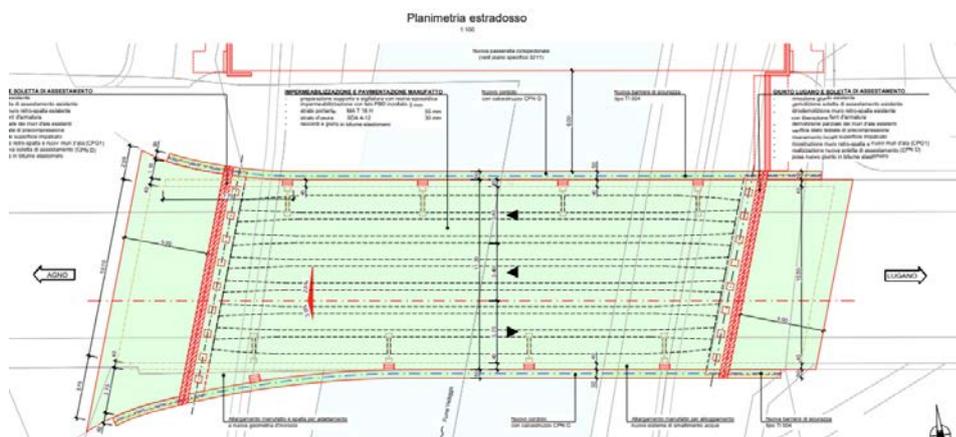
Planimetria estradosso Ponte sul Vedeggio
